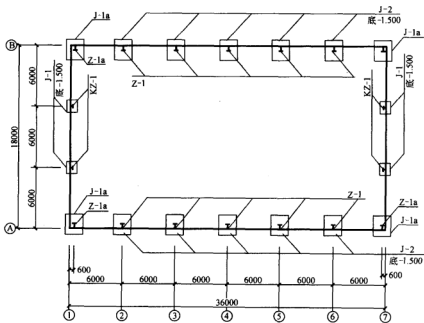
钢筋混凝土杯形基础平面布置图 1:100
